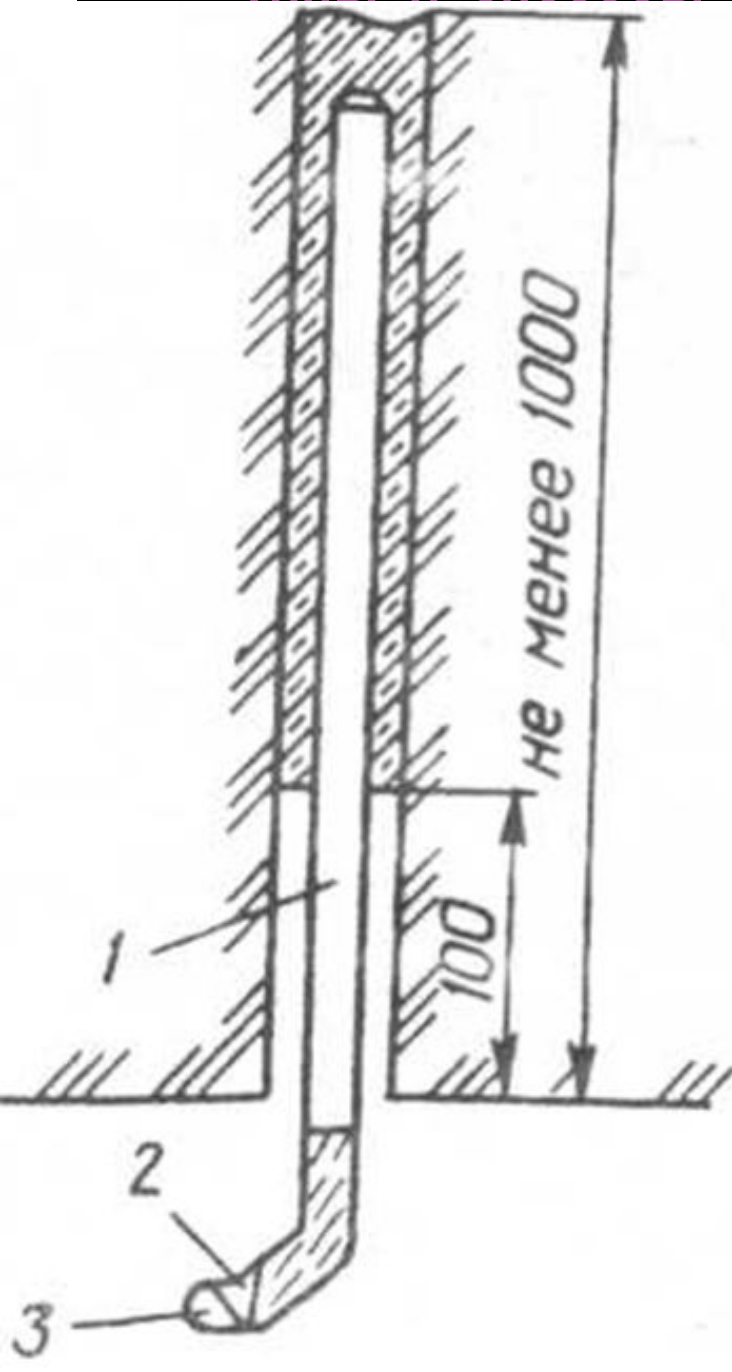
Типы стенных реперов в горных выработках - на стене или крепи горной выработки
